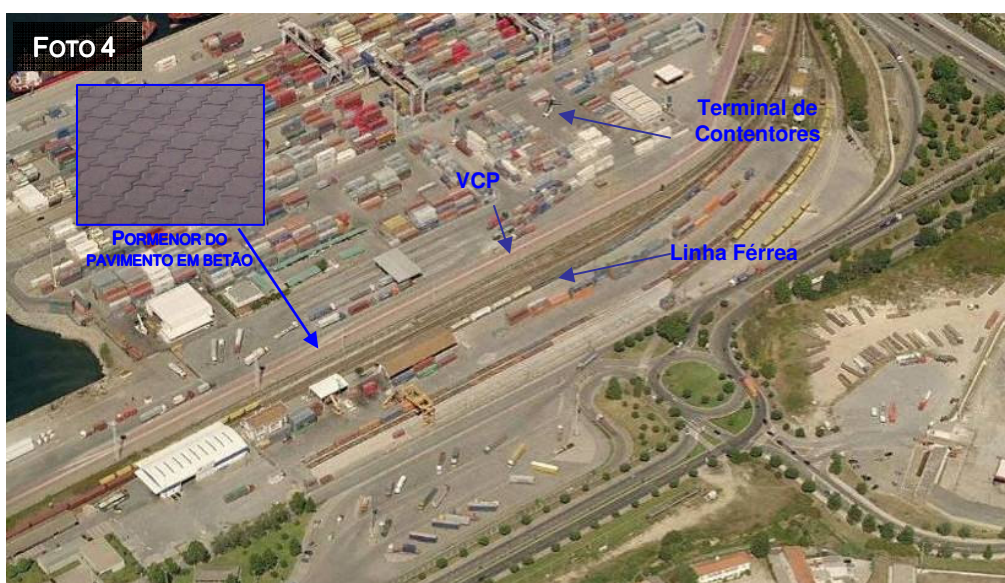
Aspecto da VCP junto ao Terminal de Contentores. Pormenor do tipo de pavimento da VCP.
